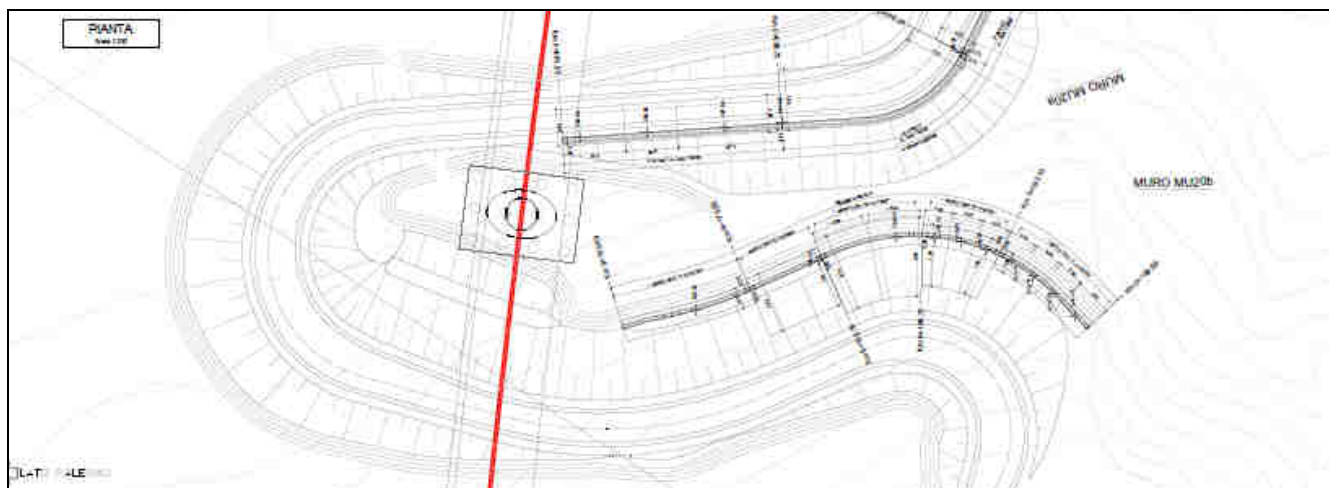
NV93: Muro di sottoscarpa MU20B - Pianta.
